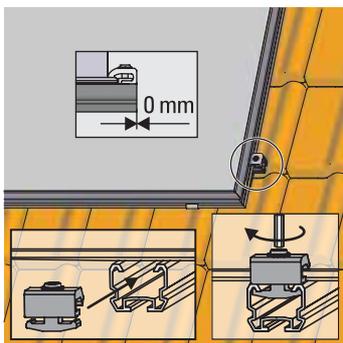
Controllare la posizione di montaggio corretta, inserire la piastrina di bloccaggio singola nella guida di montaggio inferiore e avvitare saldamente
